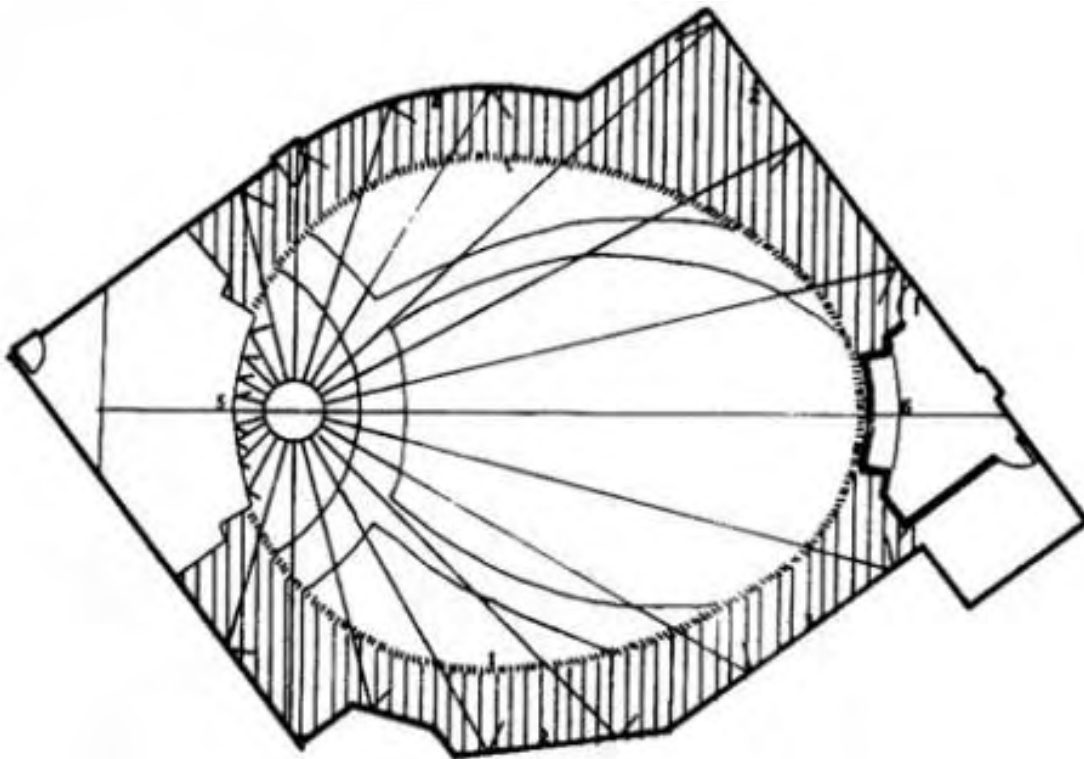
Planta Arquitectónica auditorio biblioteca Luis Ángel Arango Fuente: Germán Samper, (1958).
